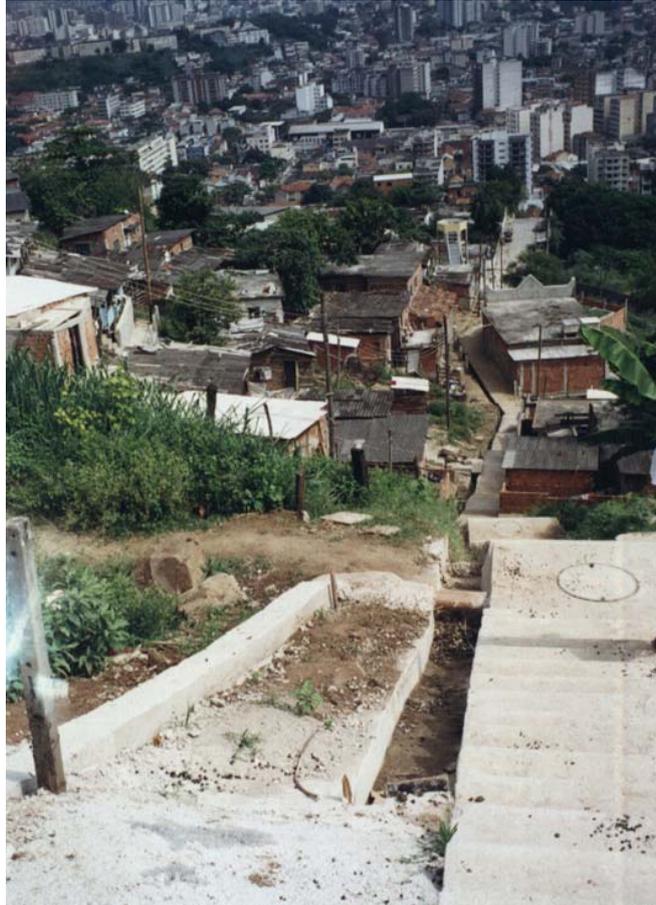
A abertura de ruas com galerias pluviais no Morro da Formiga (Foto da autora, 2000)
